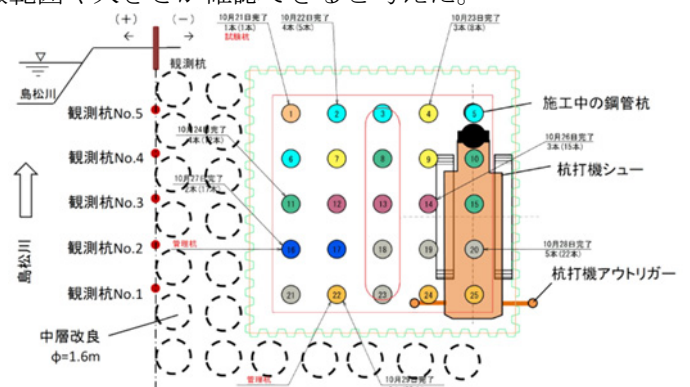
観測杭及び地盤改良体配置図 (P2 橋脚)
